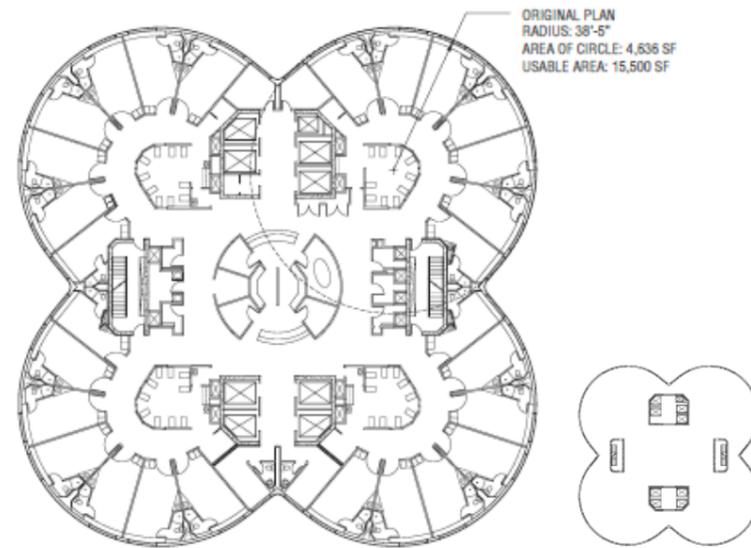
Grundriss Prentice Women's Hospital, Chicago, 1975
